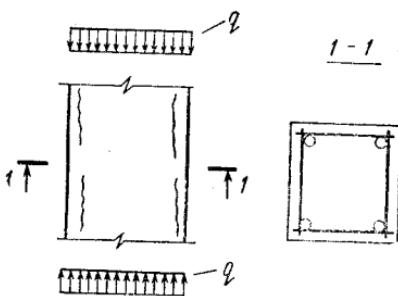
Трещины вдоль продольной арматуры в сжатых элементах
